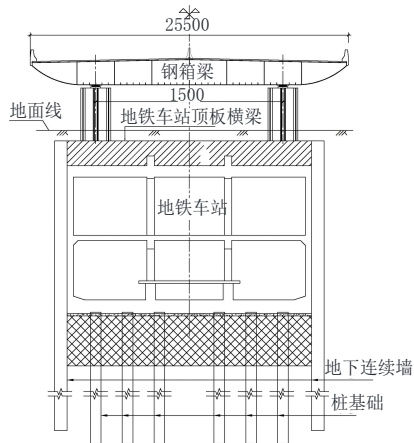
城市桥梁与非运营地铁车站结合设计断面图(单位:mm)
